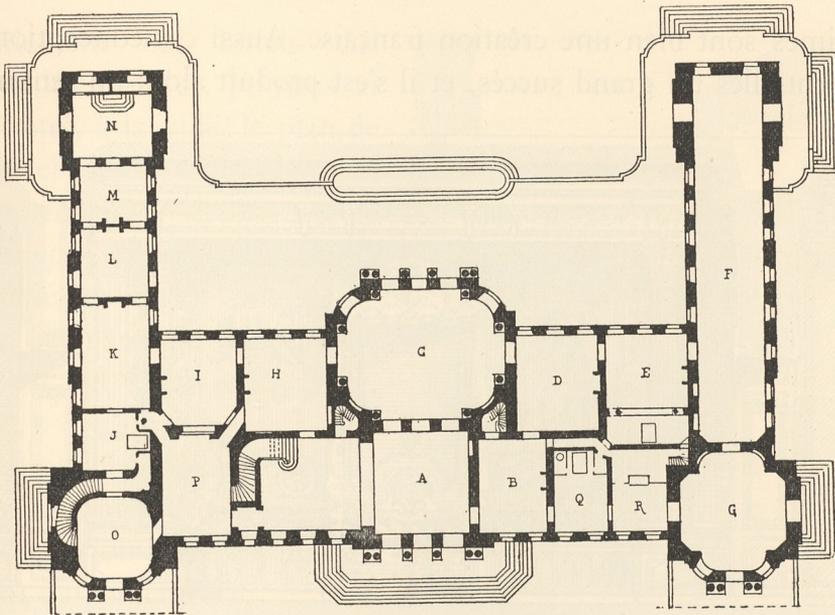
Plan d'une habitation de plaisance, d'après Blondel. — Rez-de-chaussée.
